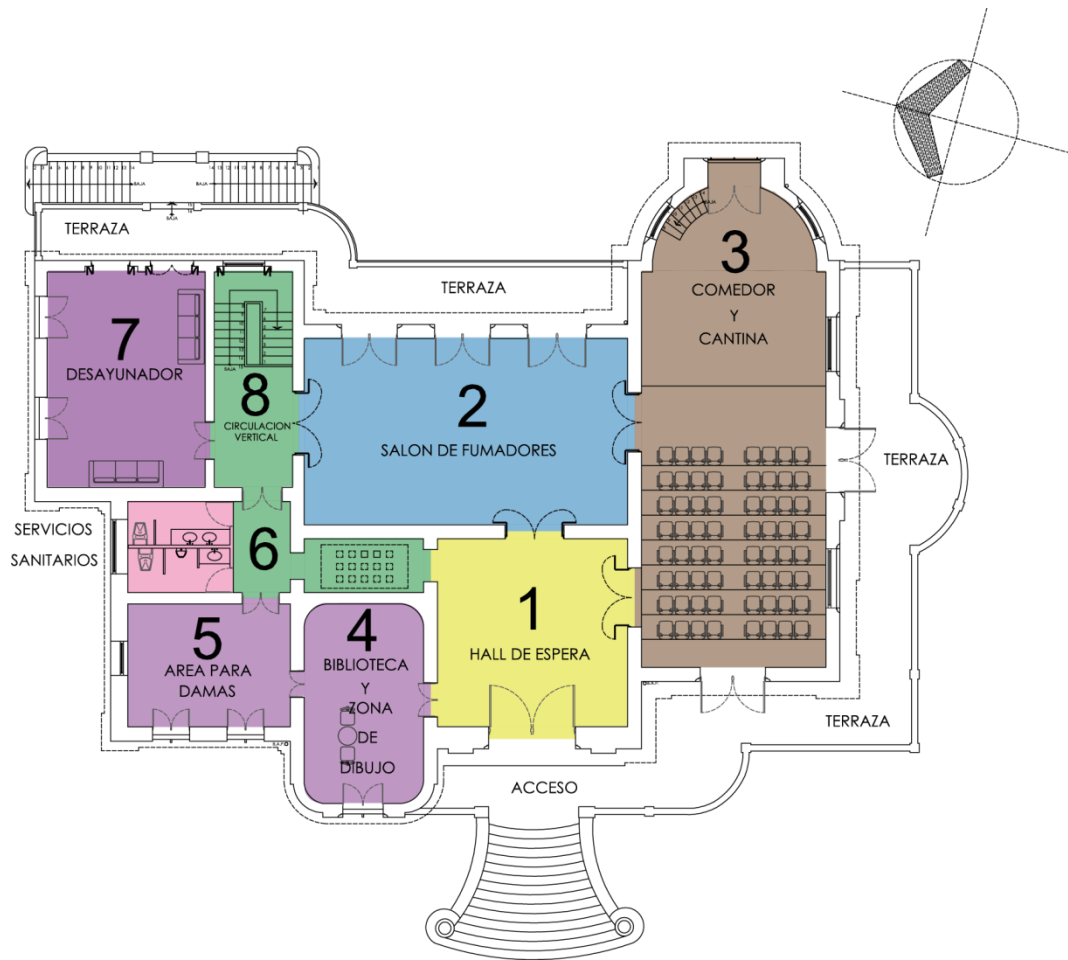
Uso Original Planta Principal de la Casa del Lago 1908.
